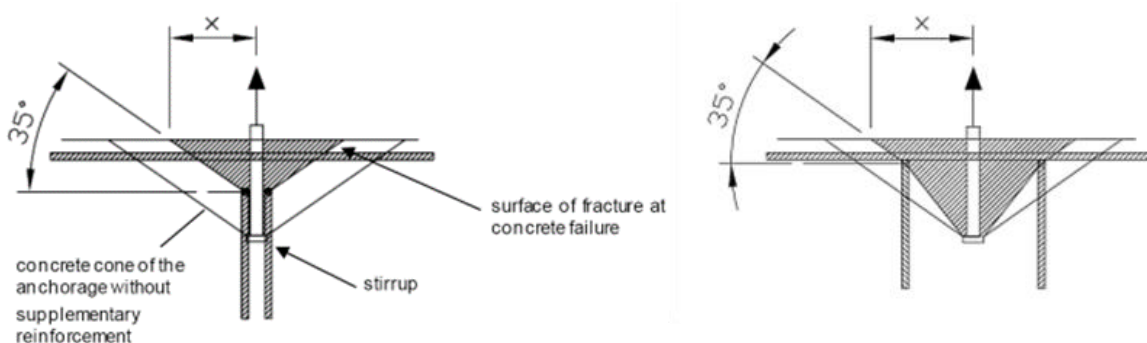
Abstand zwischen dem Kopfbolzen und dem Riss auf der Betonoberfläche
